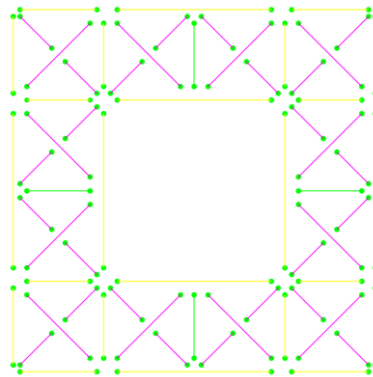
a Planta de piso “tipo”, incluyendo la disposición de los arrostramientos de piso con posición y conectividad [elaboración propia]
